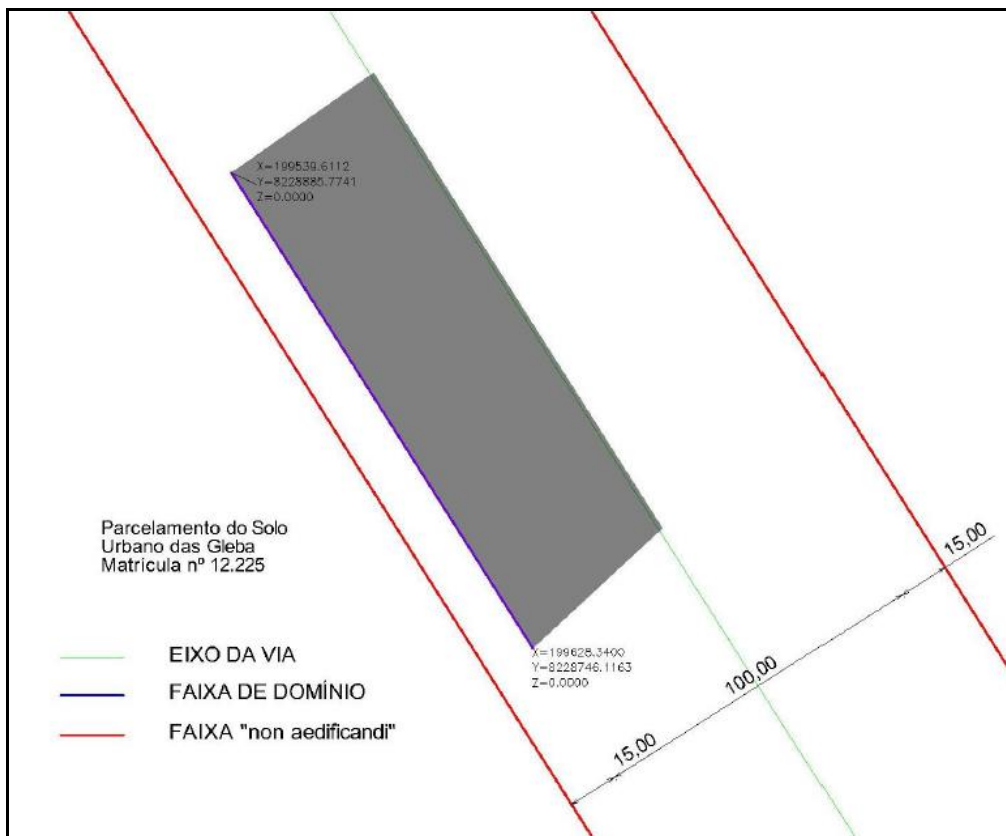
Planta de Interferência Faixa de Domínio – DER.
